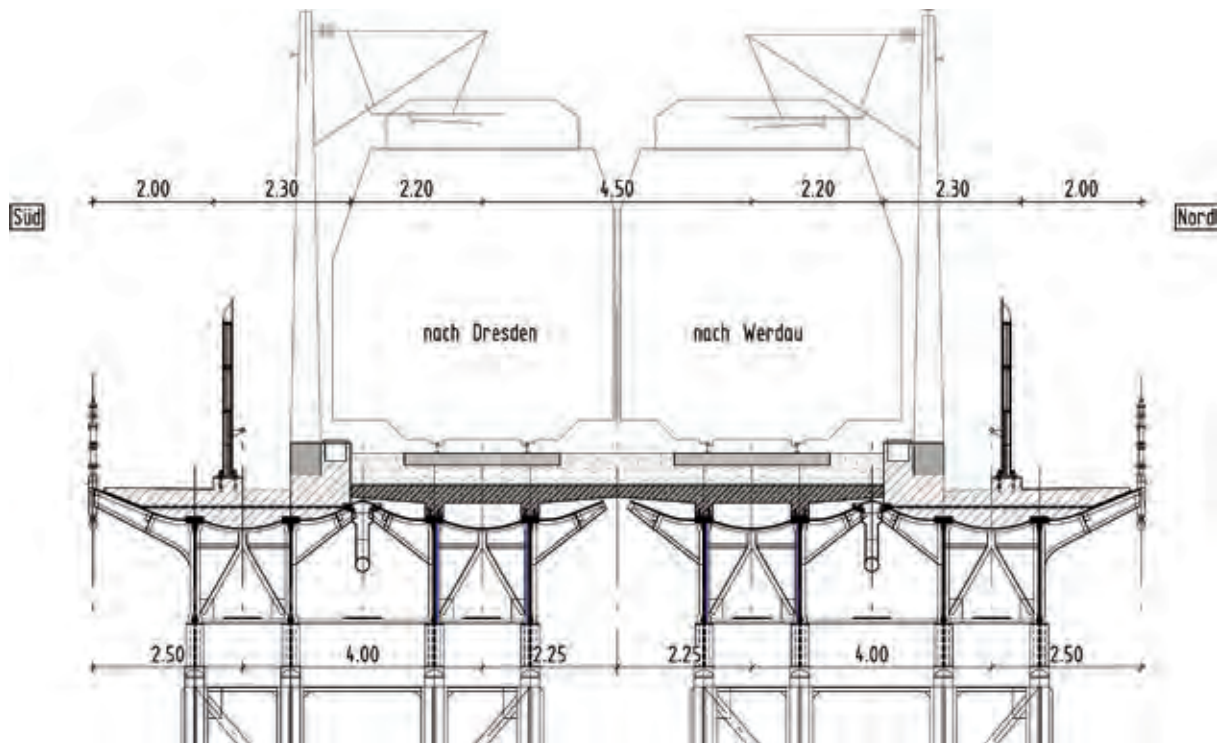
Querschnittsausführung mit Ergänzung einer Stahlbetonplatte zur Entlastung der Buckelbleche
